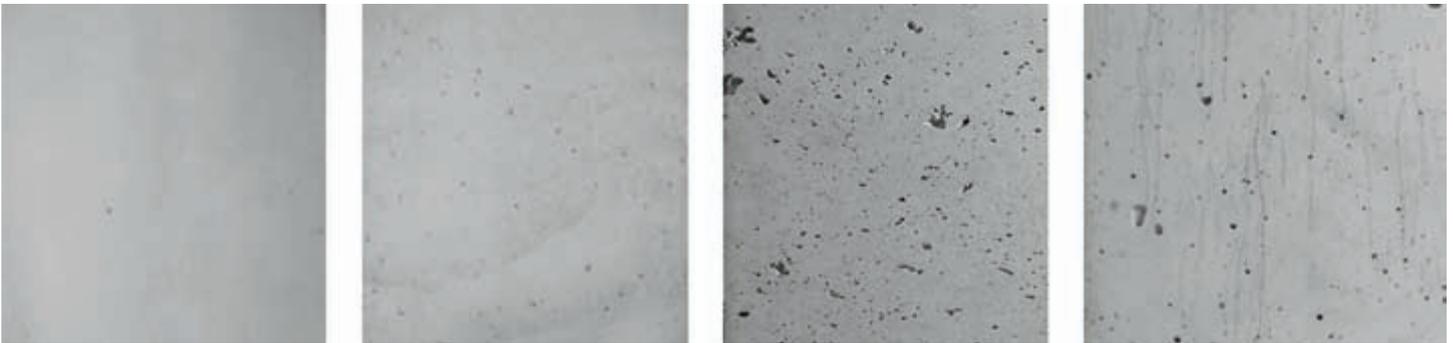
Oberflächengestalt und Mängel bei Sichtbeton
